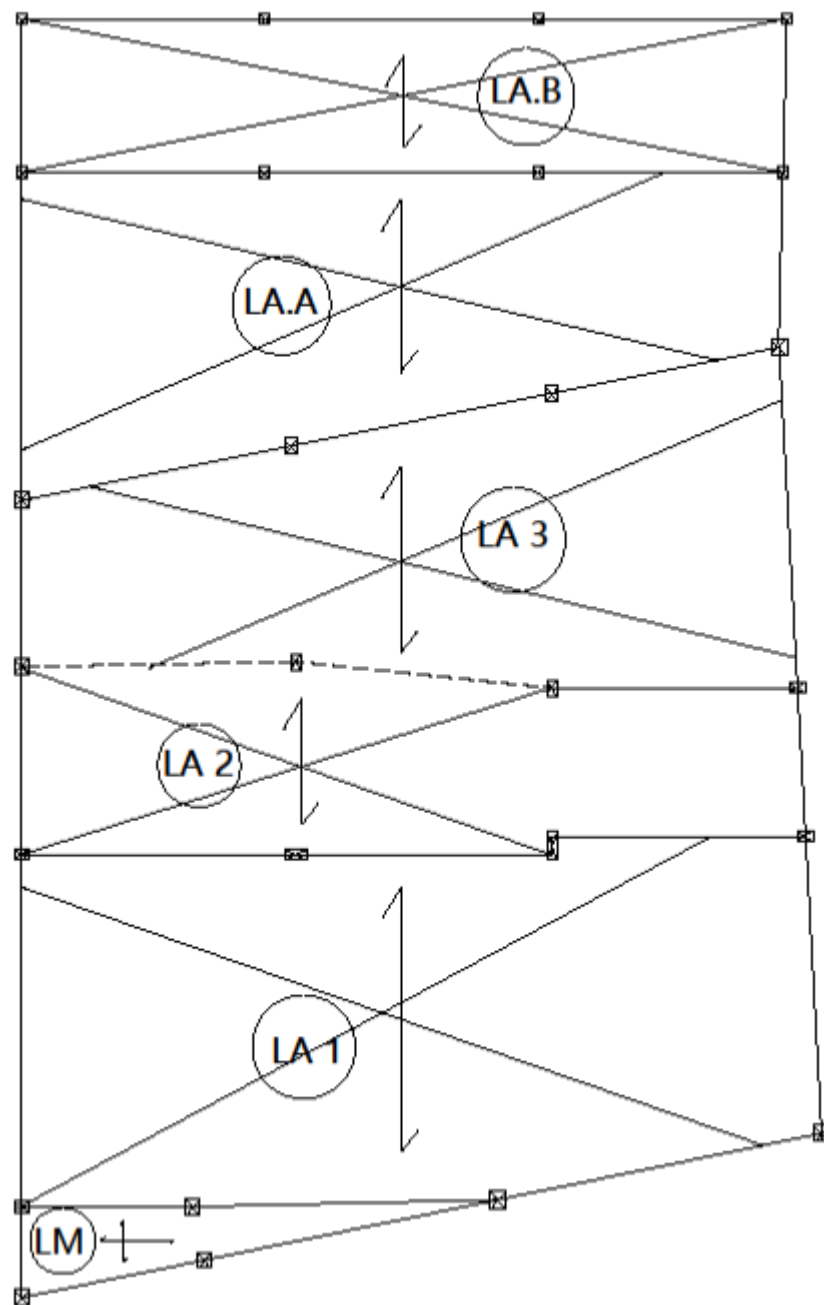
Elementos estruturais lajes (escala 1:100)
